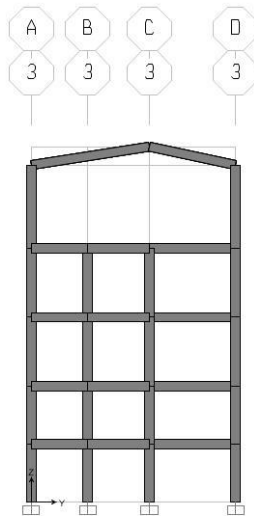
Elementos estructurales en el cuadrante “yz” sobre el eje “3”.
